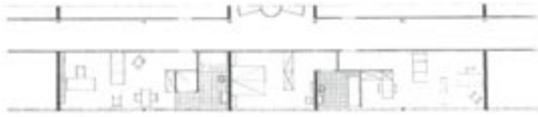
Lilly Reich, Grundriss der Zwei- und Einraumwohnung, Bauausstellung, Berlin 1931.
